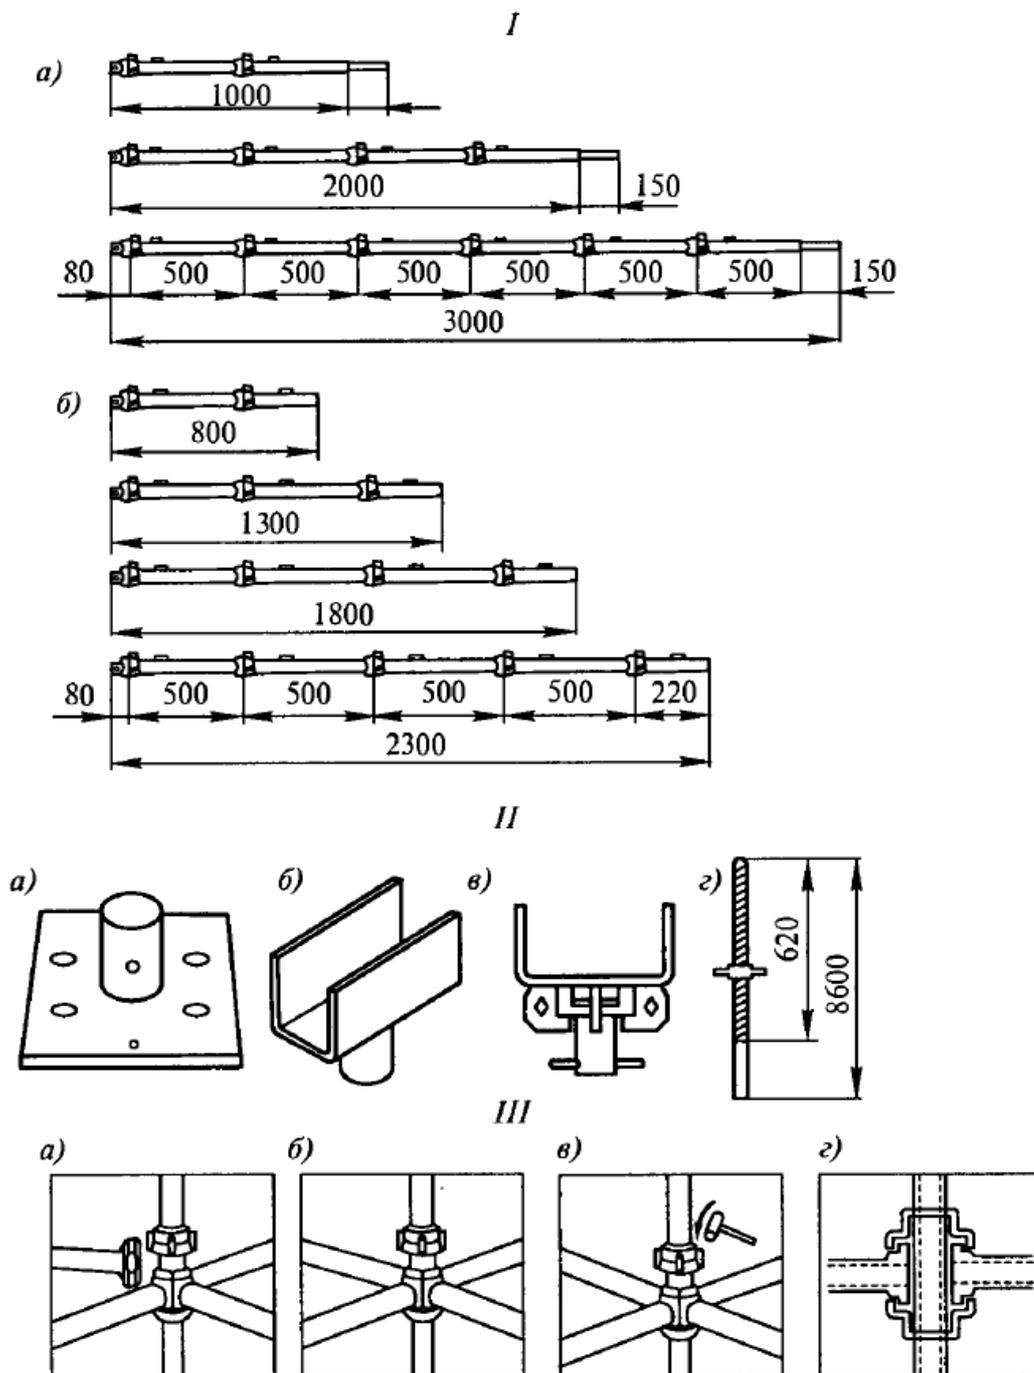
Опалубка перекрытий фирмы «Каплок» — опорные стойки
